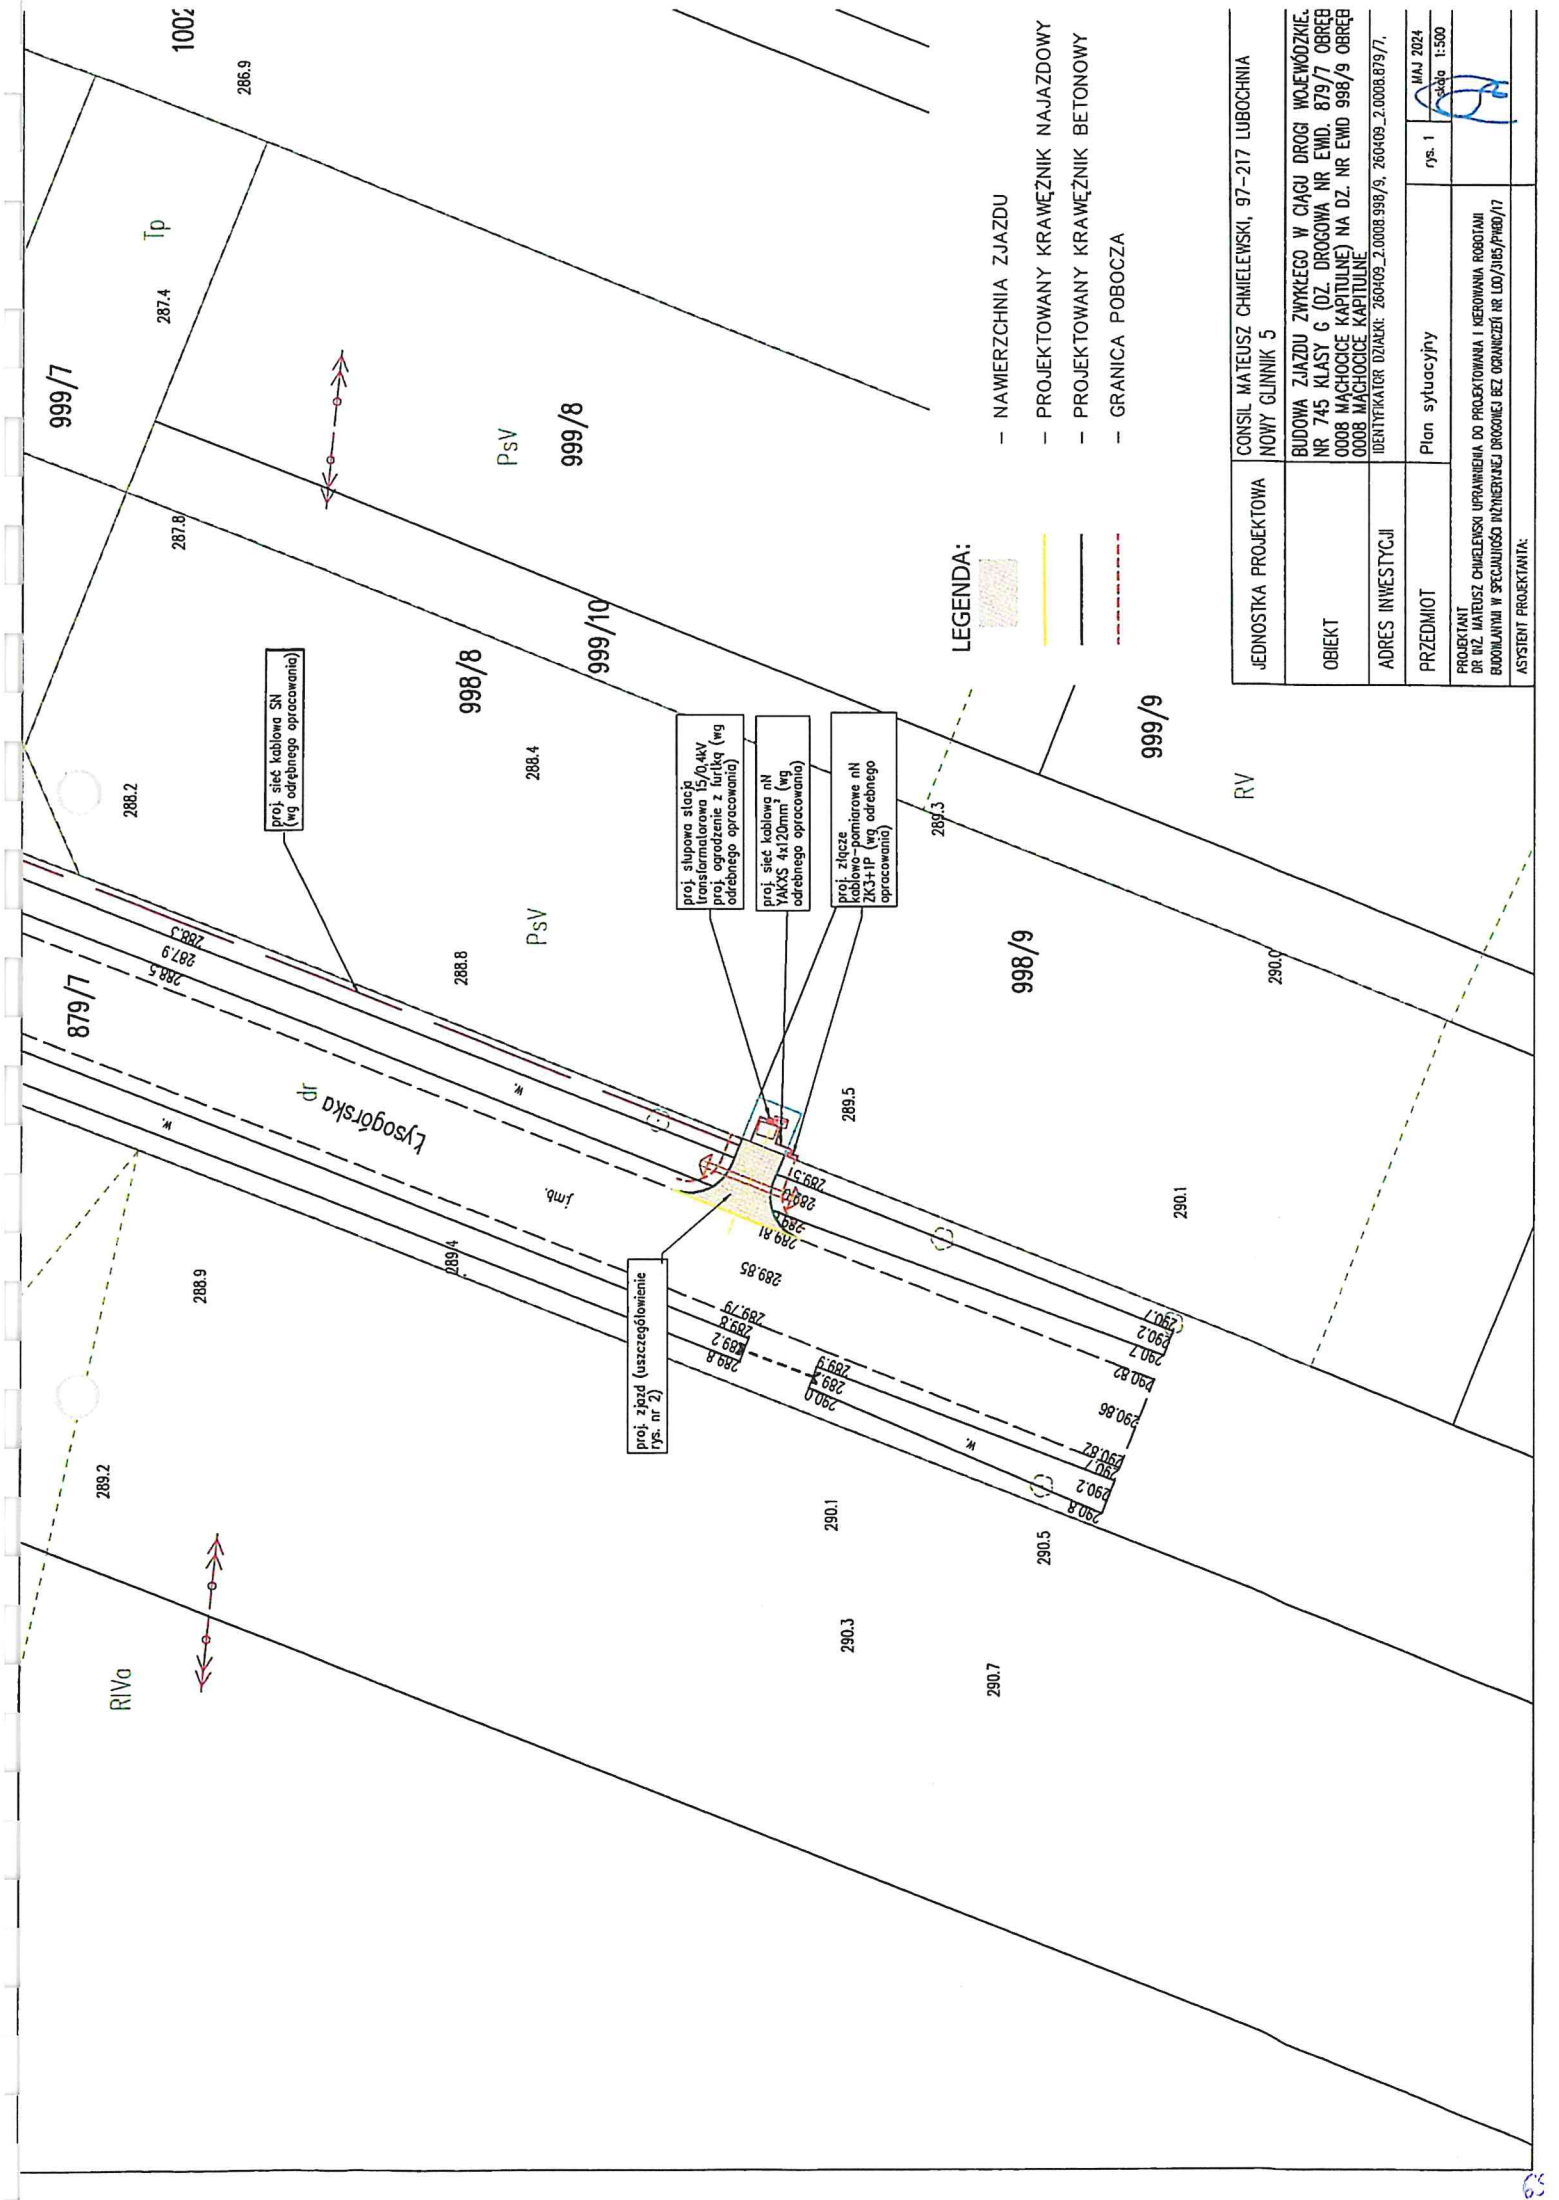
Plan sytuacyjny - szczegółowy 1:50
